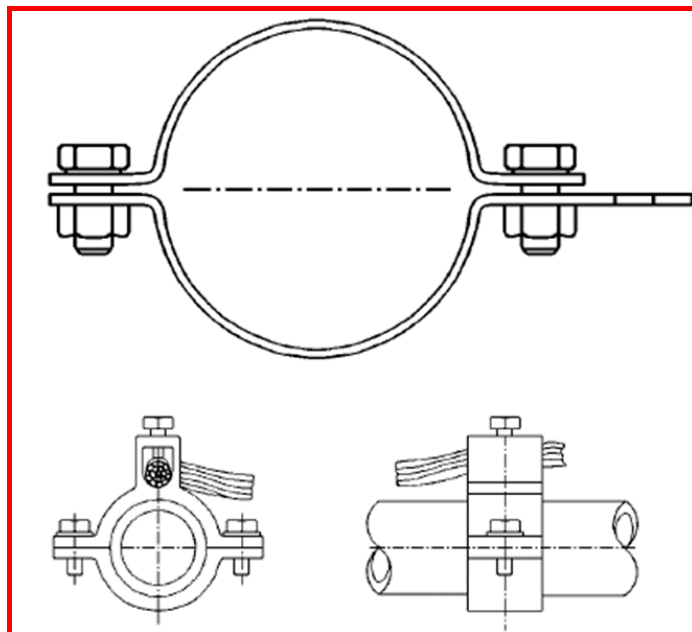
Esempio di collari per il collegamento alle tubazioni
